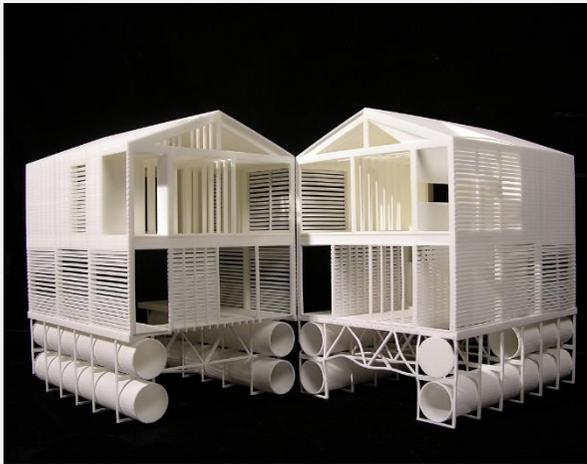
Vivienda flotante con tubos metálicos en Canadá.
